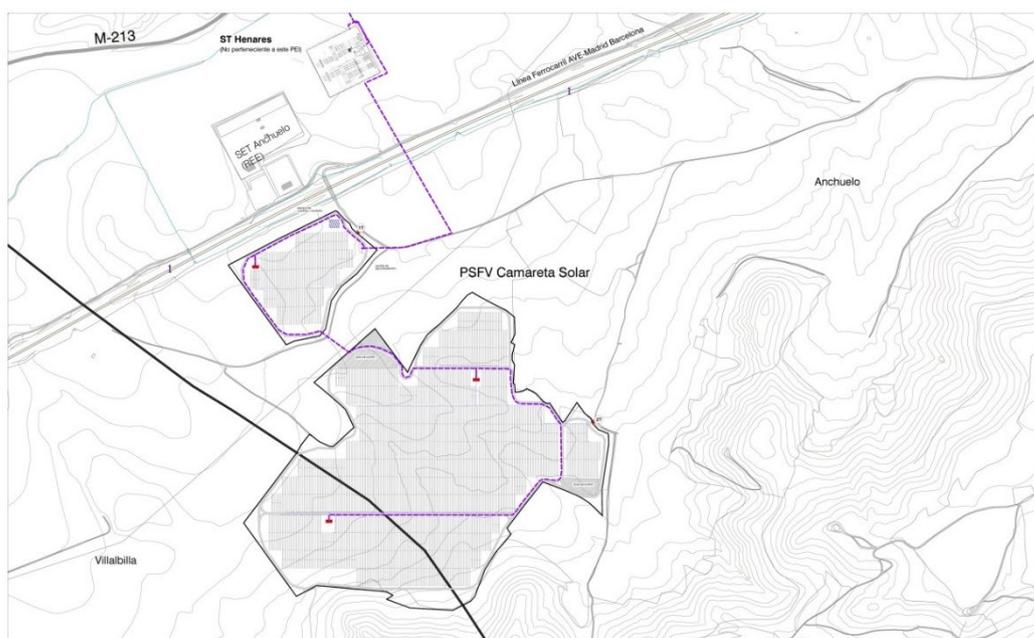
Detalle de implantación de los elementos de la infraestructura. Fuente: RH Estudio.
